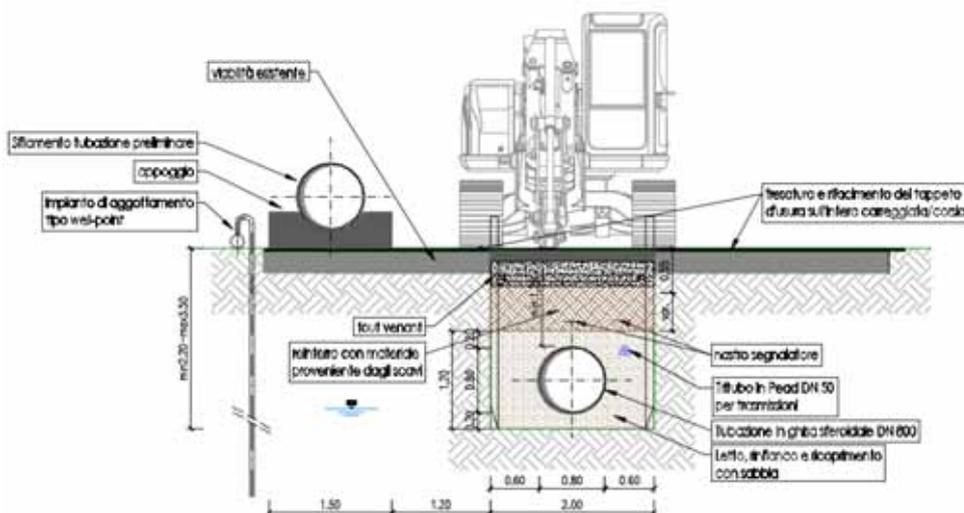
Sezione tipo 3 di scavo e di posa su strada comunale
